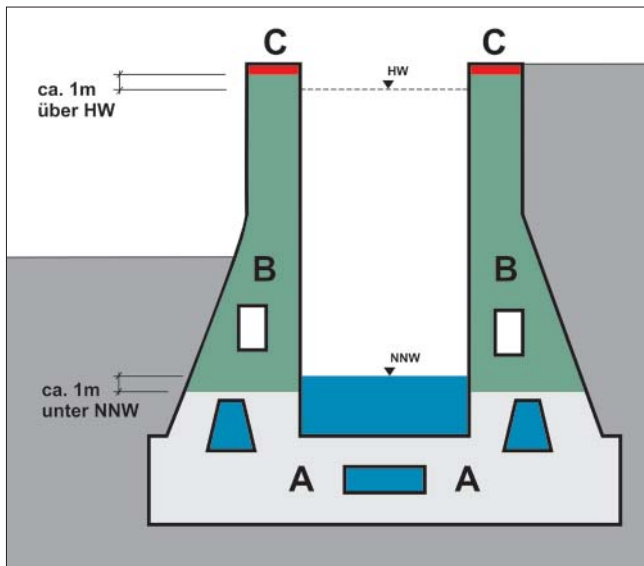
Betone für Schleusenbeispiel gemäß Abschnitt 2.2.2
